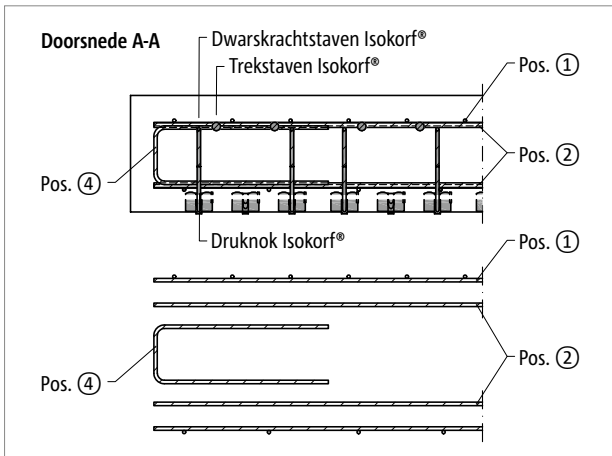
Schöck Isokorf® CXT type K-E: bijlegwapening; vloerrand met randbalk
